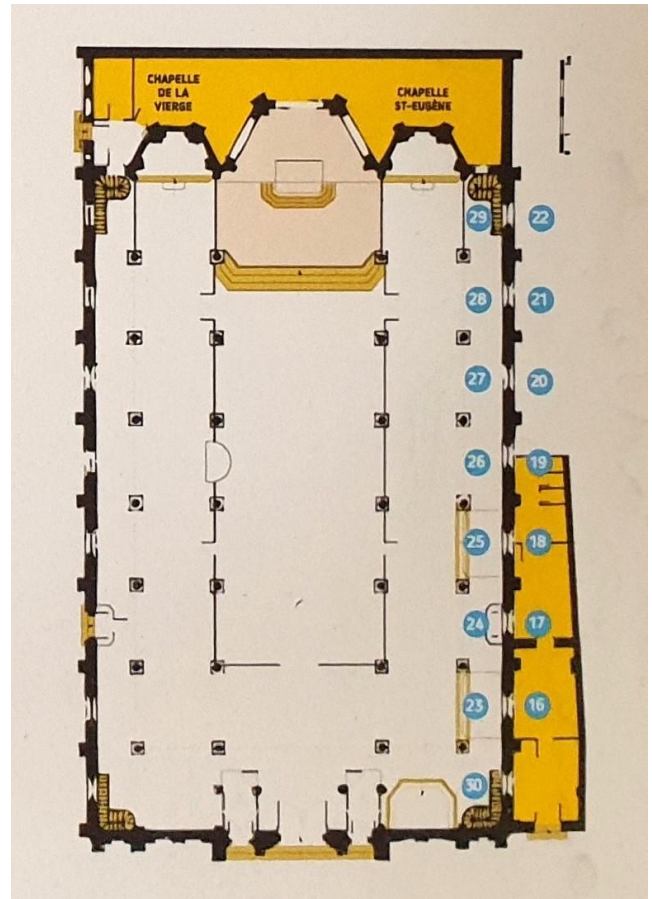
Grundriss von St-Eugène-Ste-Cécile
